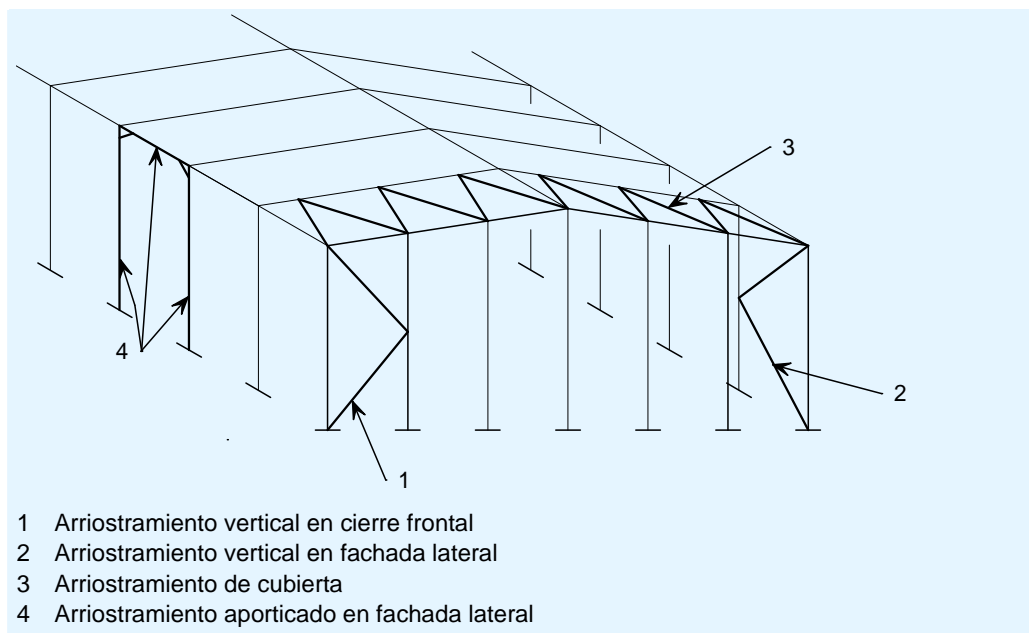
Arriostramiento aporticado en una zona de una fachada y arriostramiento fachada opuesta
